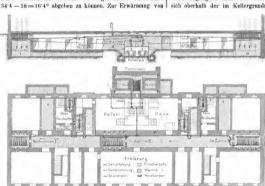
Längsschnitt und Grundriss der Schule V. Bez., Embelgass
